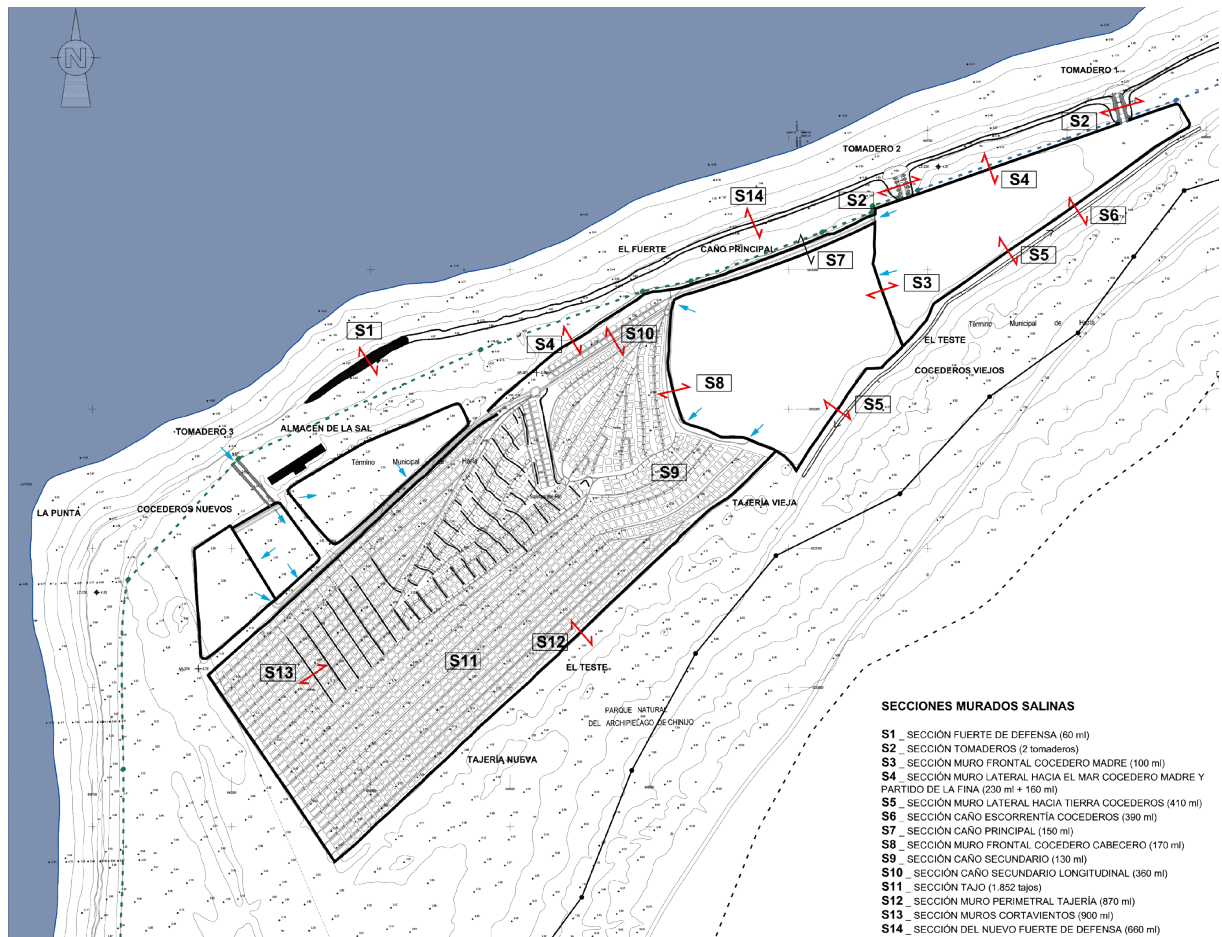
Planta secciones constructivas. Fuente: Proyecto de ejecución restauración paisajística de las Salinas del Río [4].
